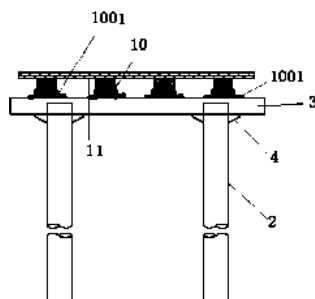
河道泄洪区域水下桩承台的施工方法中平台的施工图
